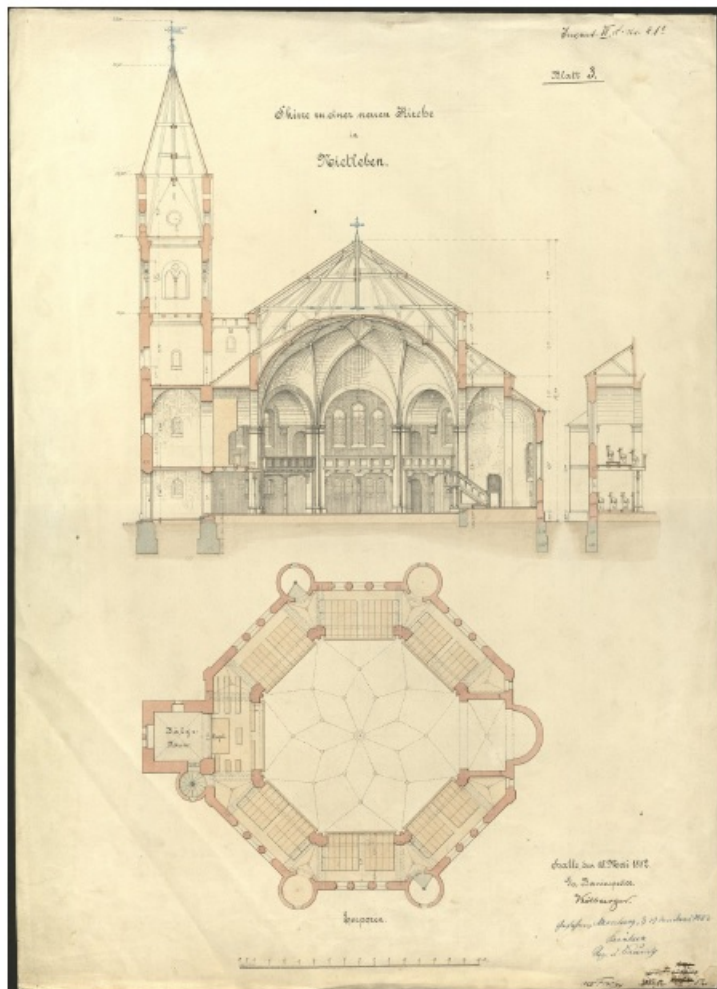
Der erste Entwurf von Kilburger, Längsschnitt und Grundriss, 1882 (LASA, Rep. C 55 Halle Z 39, Bl. 95)
